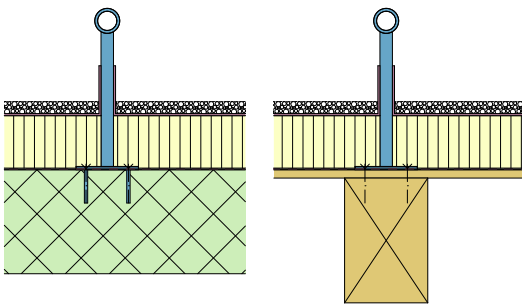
Ausstattungskategorie 1: EAP auf einem wärmegeämmten Flachdach eingebaut, Variante auf einer Beton- und einer Holzunterkonstruktion
